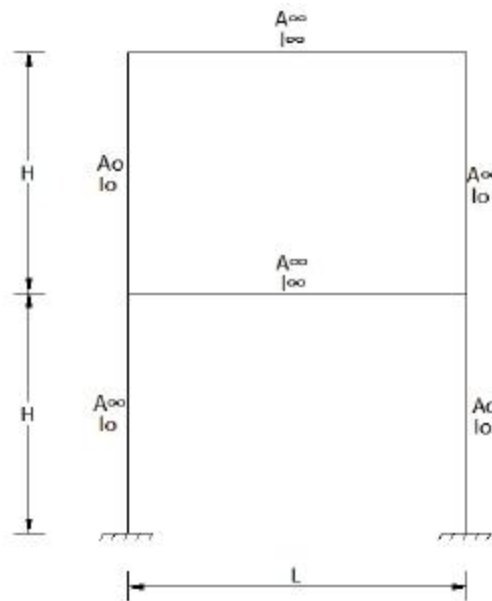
Estructura con vigas totalmente rígidas y con dos columnas axialmente rígidas.
